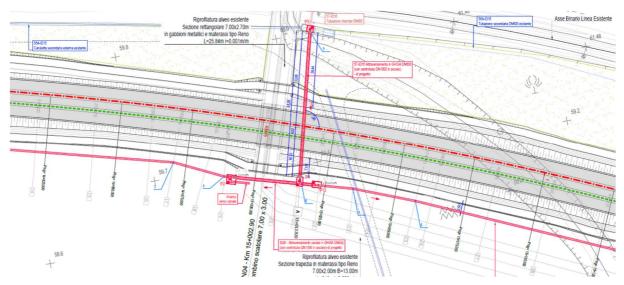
Attraversamento pk 15+013,920 - Stralcio Planimetrico
